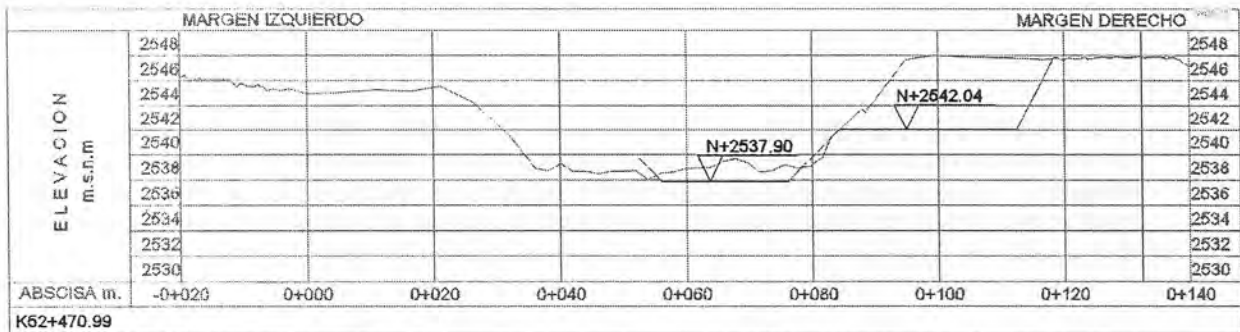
Sección transversal K52+470.99 (Sección Récord). Nivel de fondo: 2537.90
